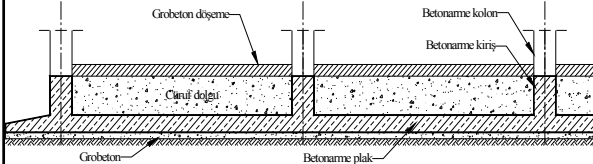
Düz kirişli plak temellere ilişkin bir örnek
